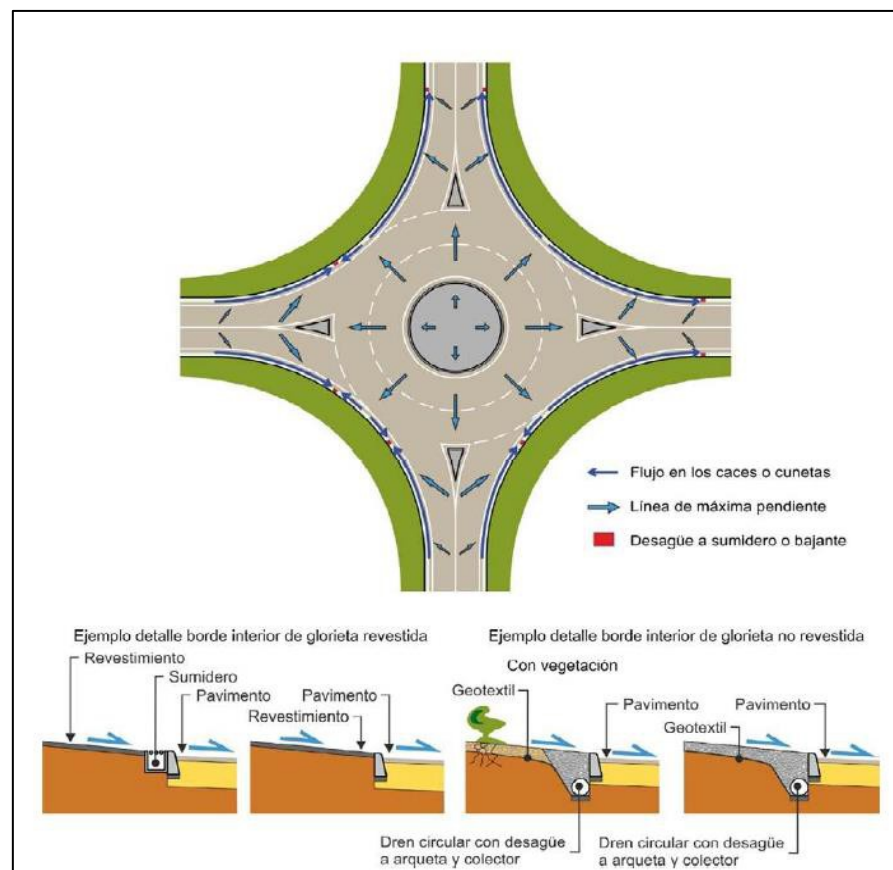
Ejemplo de disposición de elementos de drenaje en una rotonda
